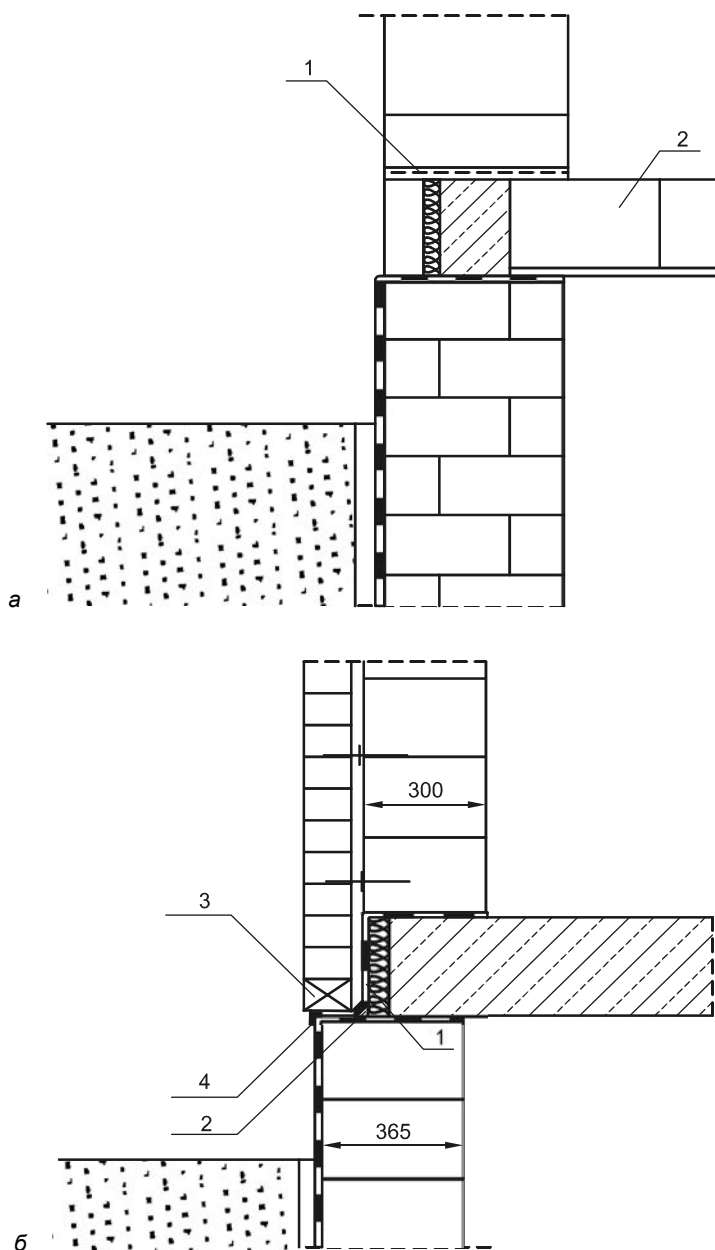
Сопряжение стены из пенобетонных блоков с подвальной стеной из водостойкого кирпича (а) и пенобетонных блоков (б)
